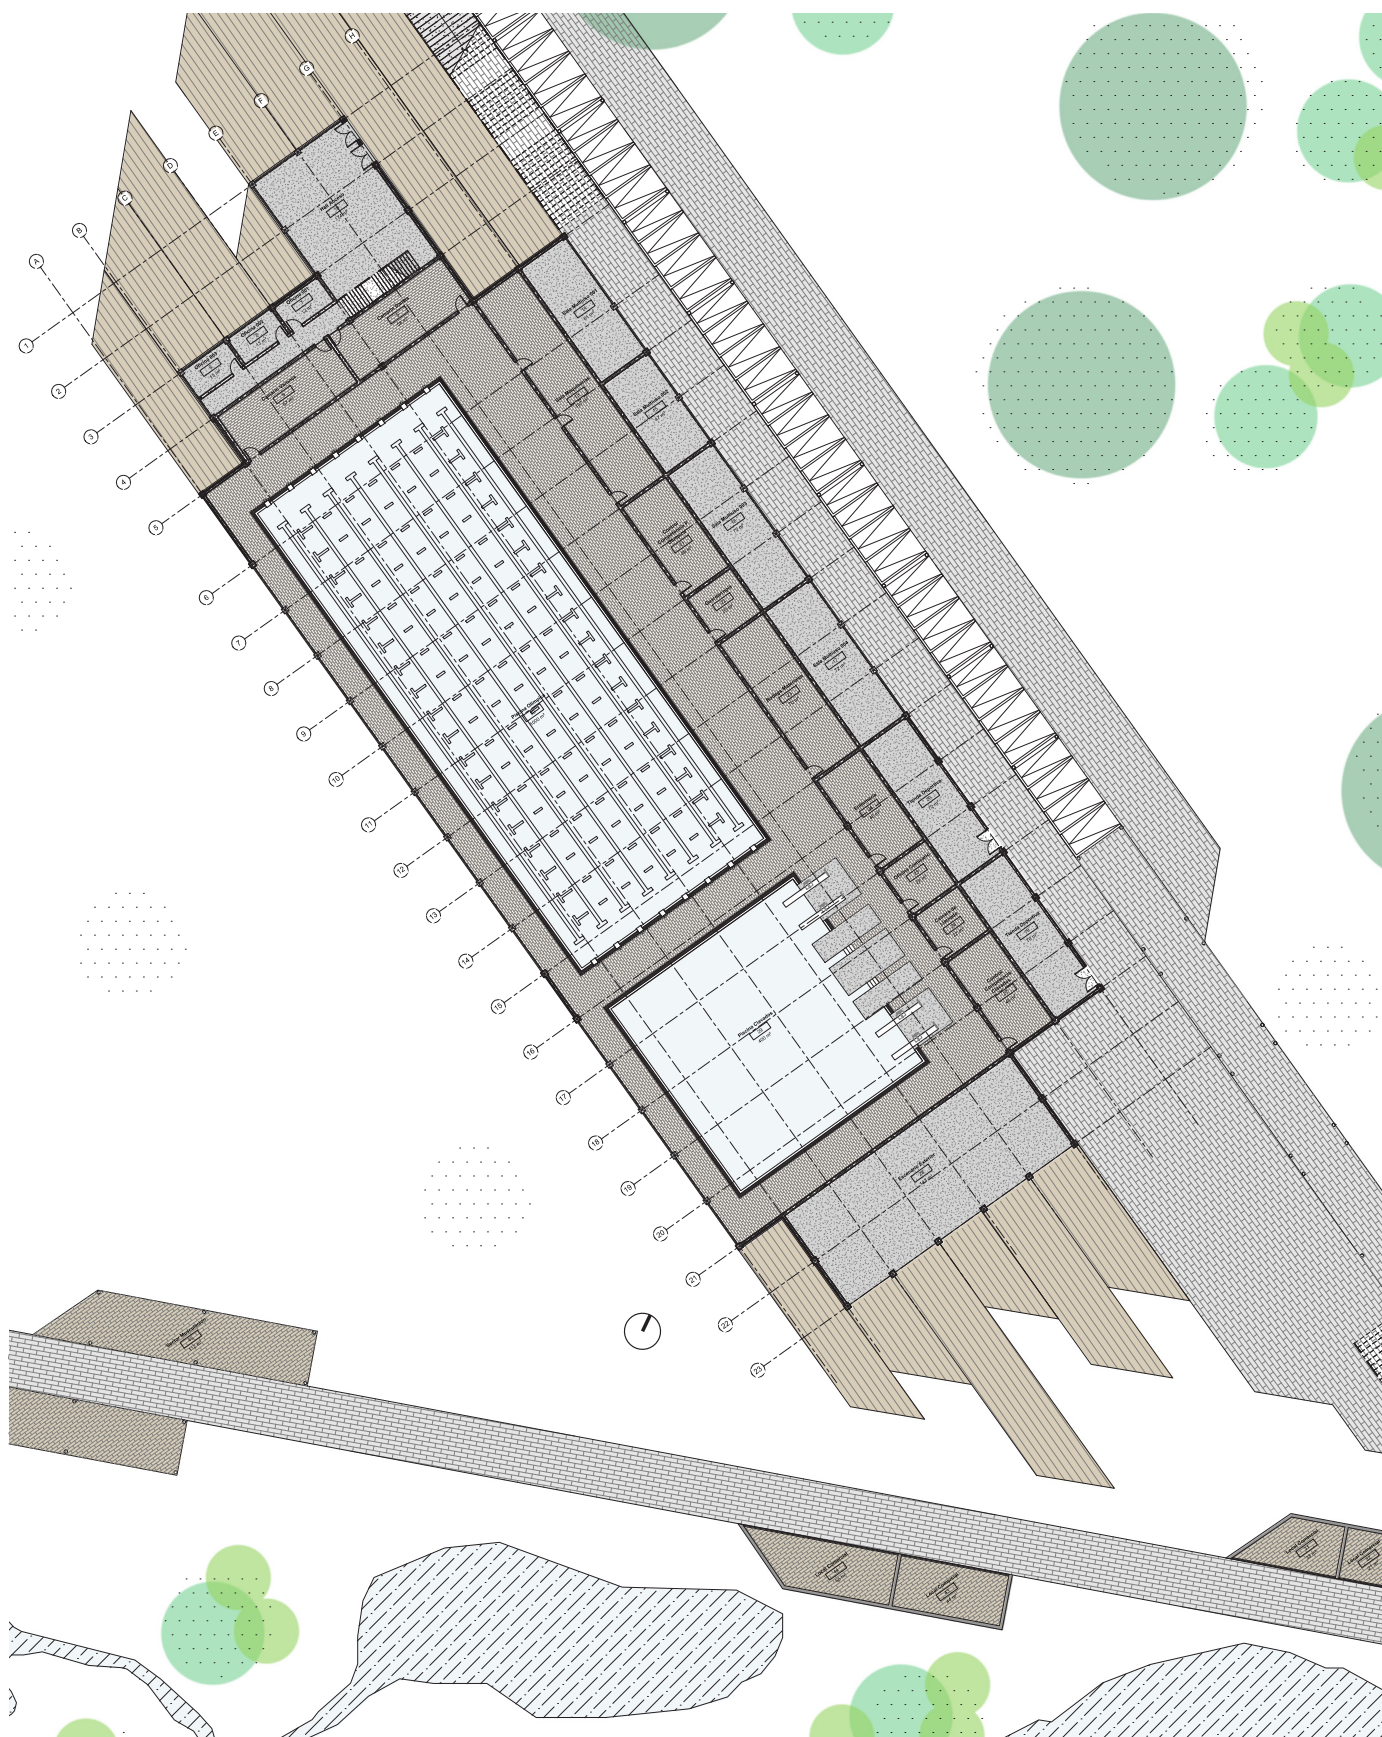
\_ Planta Centro Acuatico NPT+0.0 V2
